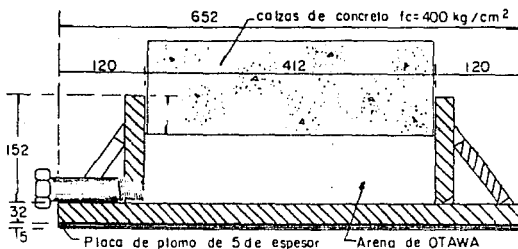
Sistema para calzar el tablero con gatos de arena.
